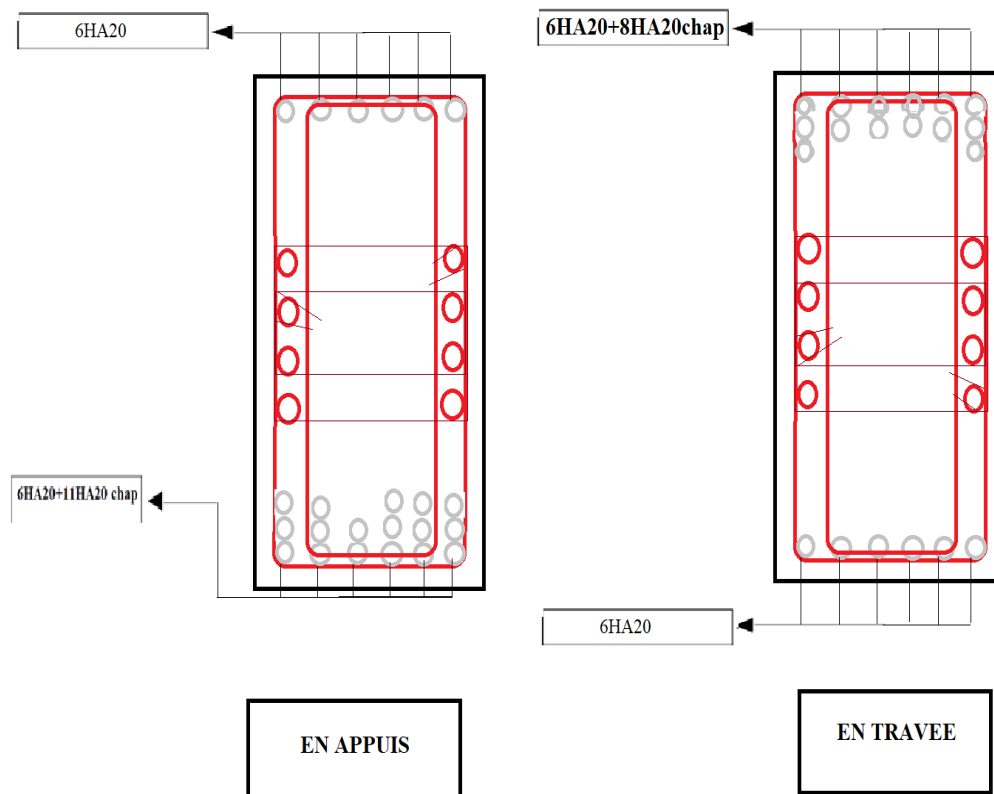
schéma de ferrailage de la poutre de rigidité
